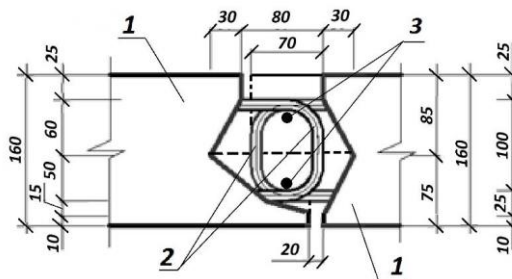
Конструкція вузла з'єднання плит перекриття: 1 - плита; 2 –арматурні випуски; 3 – арматурні стержні А500 діаметром 10 мм
